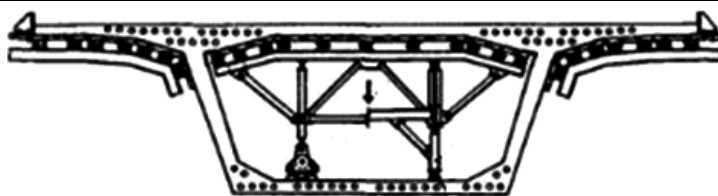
Установка щита внутренней съемной опалубки второй очереди бетонирования
